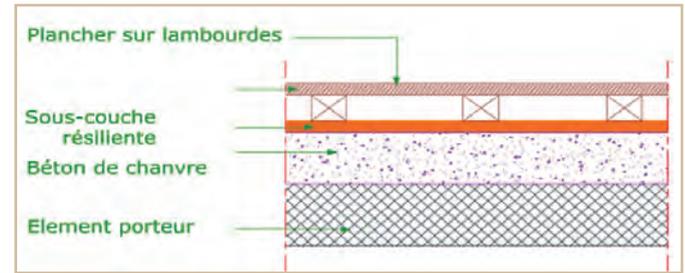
Schéma simplifié de plancher sur lambourdes sur forme de béton de chanvre
